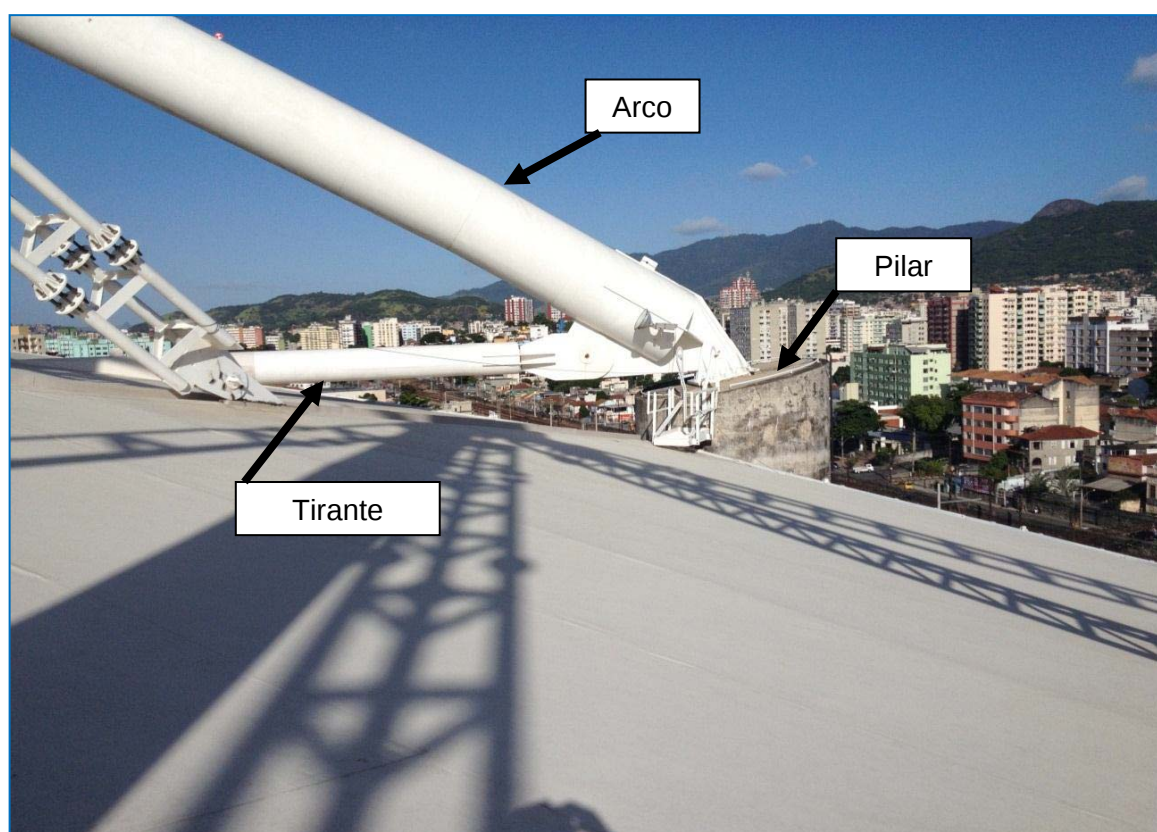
Apoio da treliça no topo da coluna de concreto e ligação do tirante à base do arco
